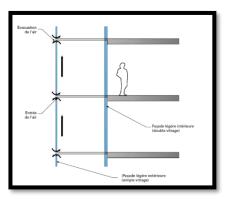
façade double peau ventilée sur l'extérieur naturellement
